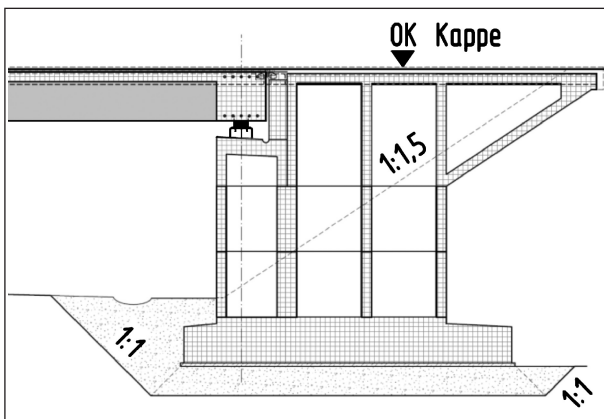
Schnitt, Stahlbetonhohlquerschnitt
